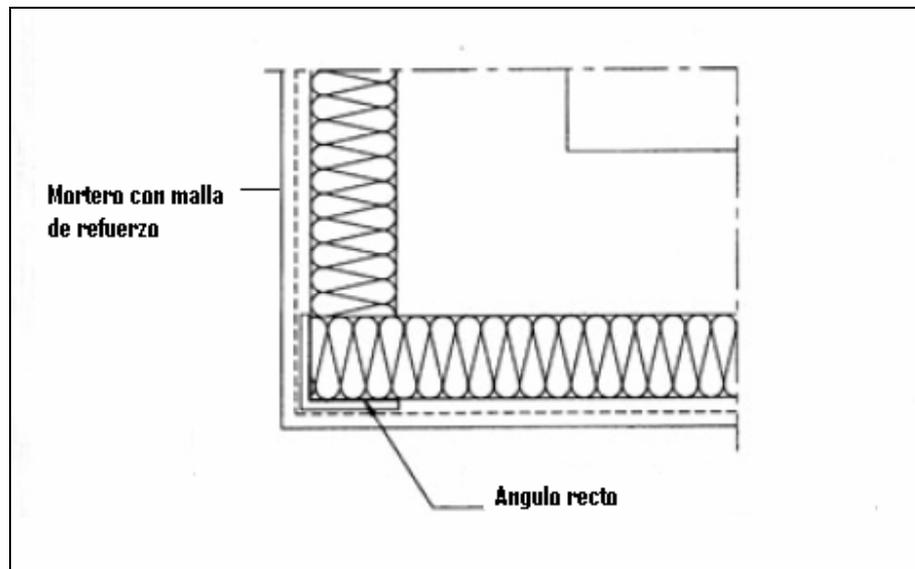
Placa en ángulo recto adosado a la aislación para reforzar encuentros de muros.
